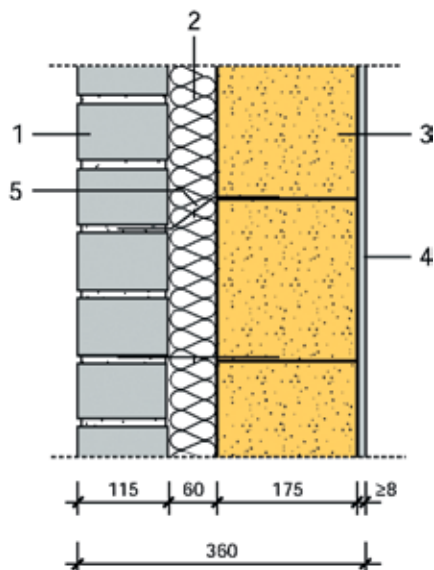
Облицовка кирпичом при наличии теплоизоляции, без вентилируемого зазора: 1 – облицовочная стена из кирпича, 2 – теплоизоляция, 3 – стена из газобетонных блоков, 4 – внутренняя штукатурка, 5 – анкер
